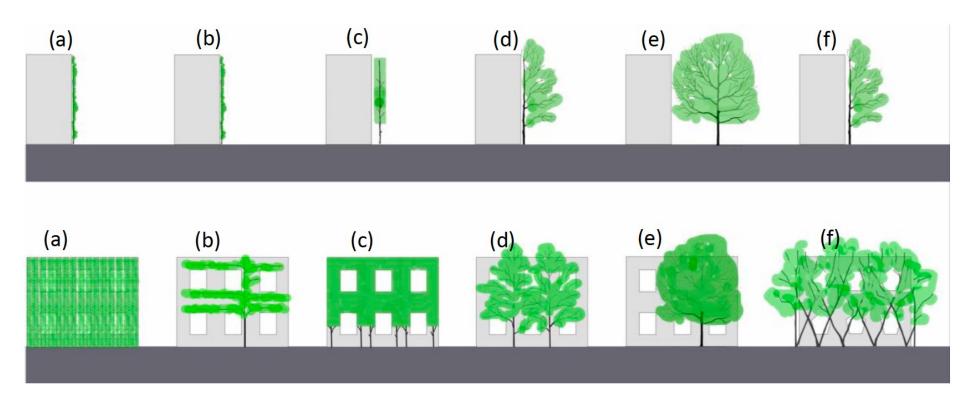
(a) bodengebundene Fassadenbegrünung, (b) Spalierbaum, (c) Hochstammhecke, (d) Baumfassade, (e) Haus vorm Baum, (f) Baubotanik Fassade in Schnitt (oben) und Ansicht (unten) (Lisa Höpfl)
